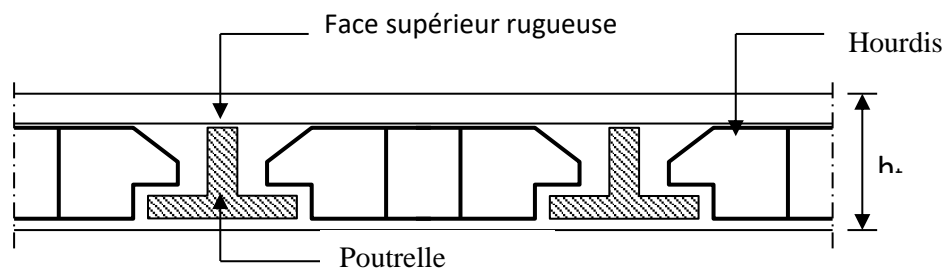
Coupe verticale du plancher à corps creux.
